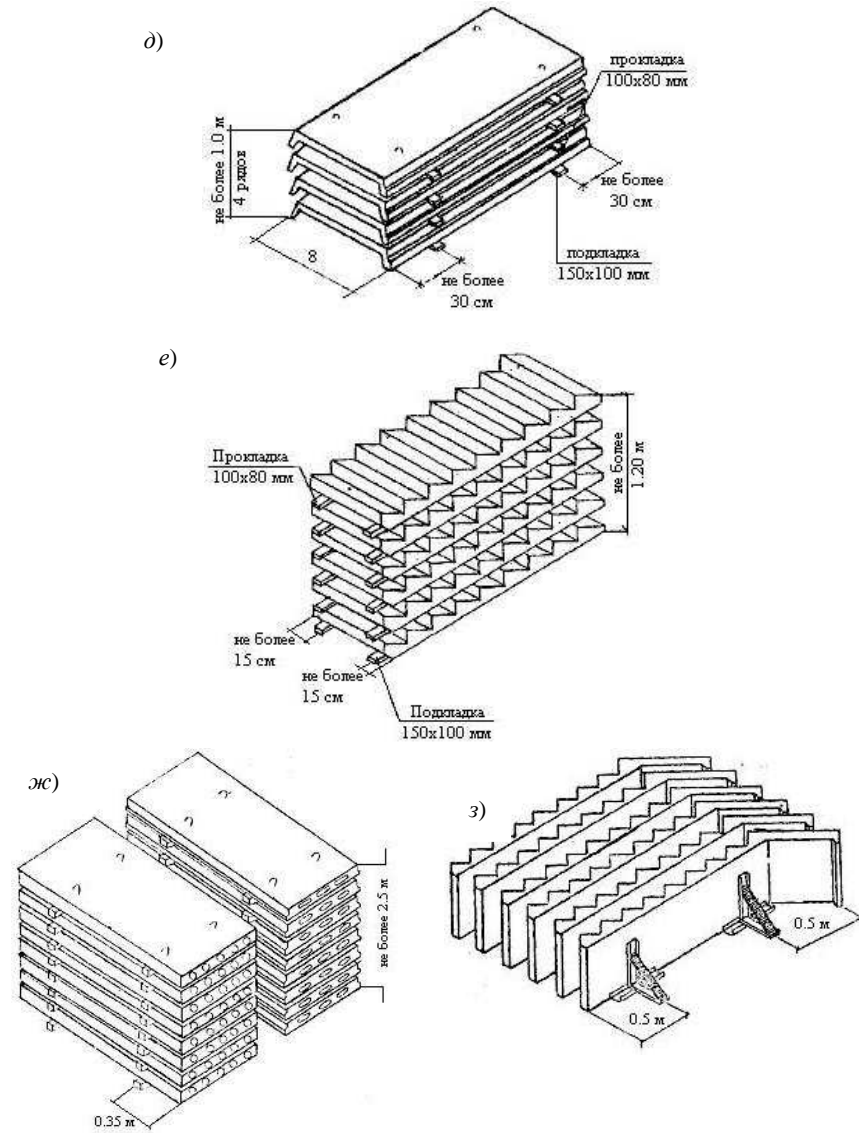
(окончание) – Схемы размещения на складе железобетонных изделий
